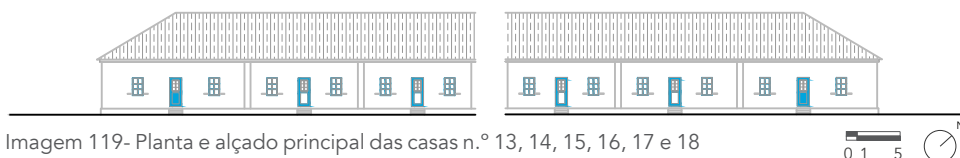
Planta e alçado principal das casas n.º 13, 14, 15, 16, 17 e 18
